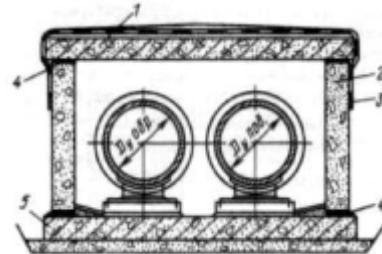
Непрохідний канал із збірних залізобетонних плит і стінових блоків: 1 – плита перекриття; 2 – стіновий блок; 3 – гідроізоляція; 4 – цементний розчин; 5 - плита днища
